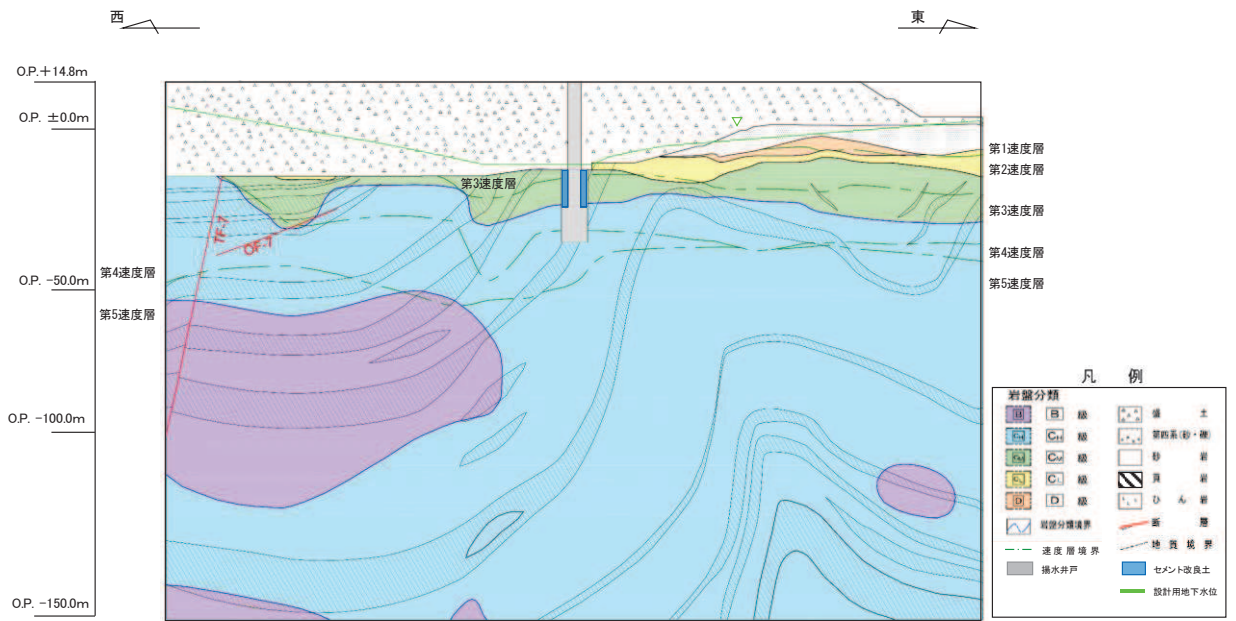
(4) No.4 揚水井戸 評価対象断面図 (D' -D 断面)
